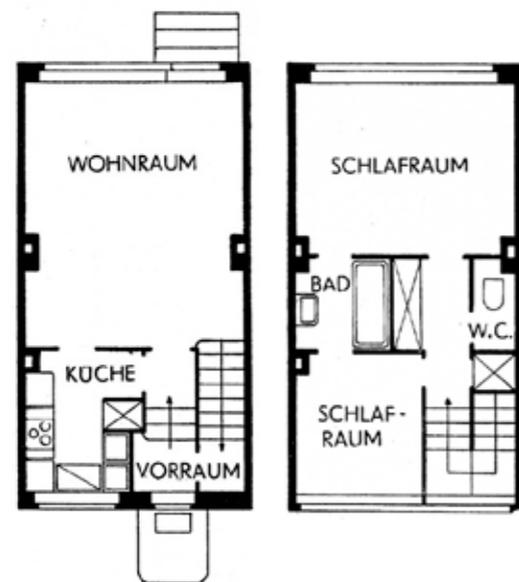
Walter Loos, Reihenhaus Werkbundsiedlung, Grundrisse Erdgeschoß und Obergeschoß
